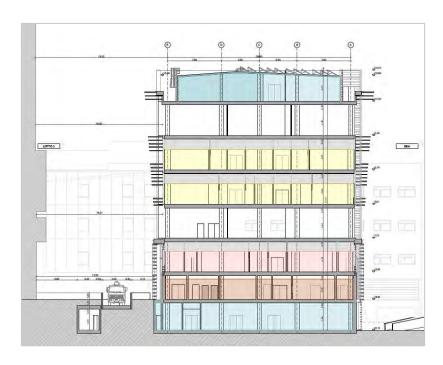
CORPO VOLANO: SEZIONE TRASVERSALE
